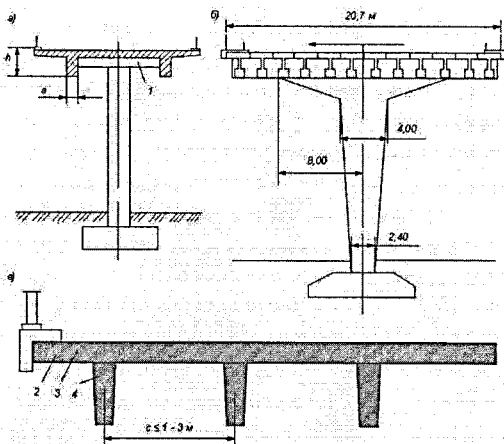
Поперечні перерізи ребристих залізобетонних естакад і шляхопроводів: 1 – опорна діафрагма; 2 – нез’ємна опалубка; 3 – монолітна плита проїжджої частини; 4 – збірний елемент – ребро
